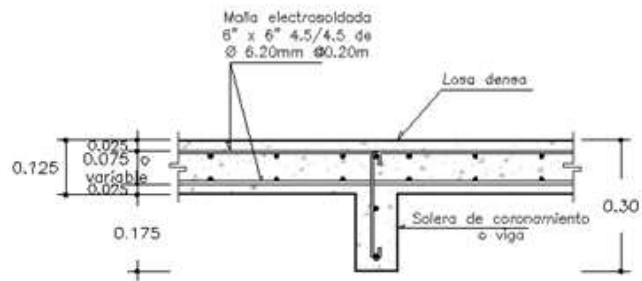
f Apoyo central de losa densa en solera de coronamiento o viga
